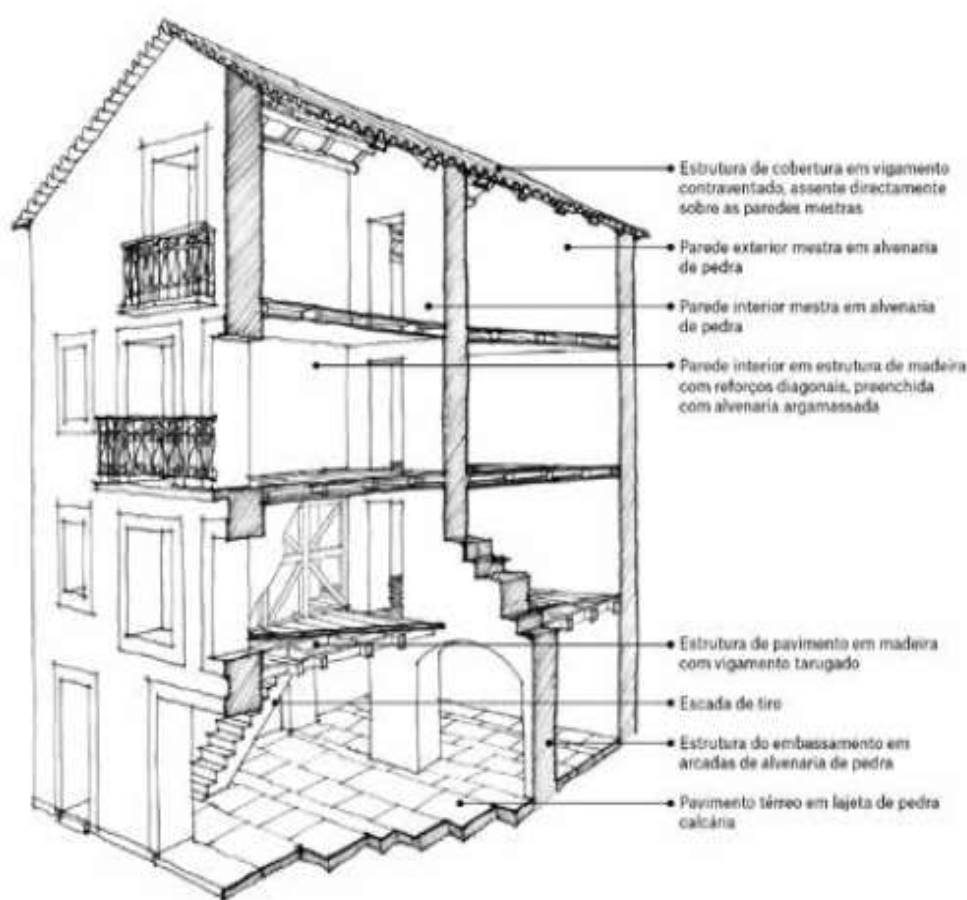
Estrutura tipo Casa Burguesa do Porto (Retirado de [18]).
